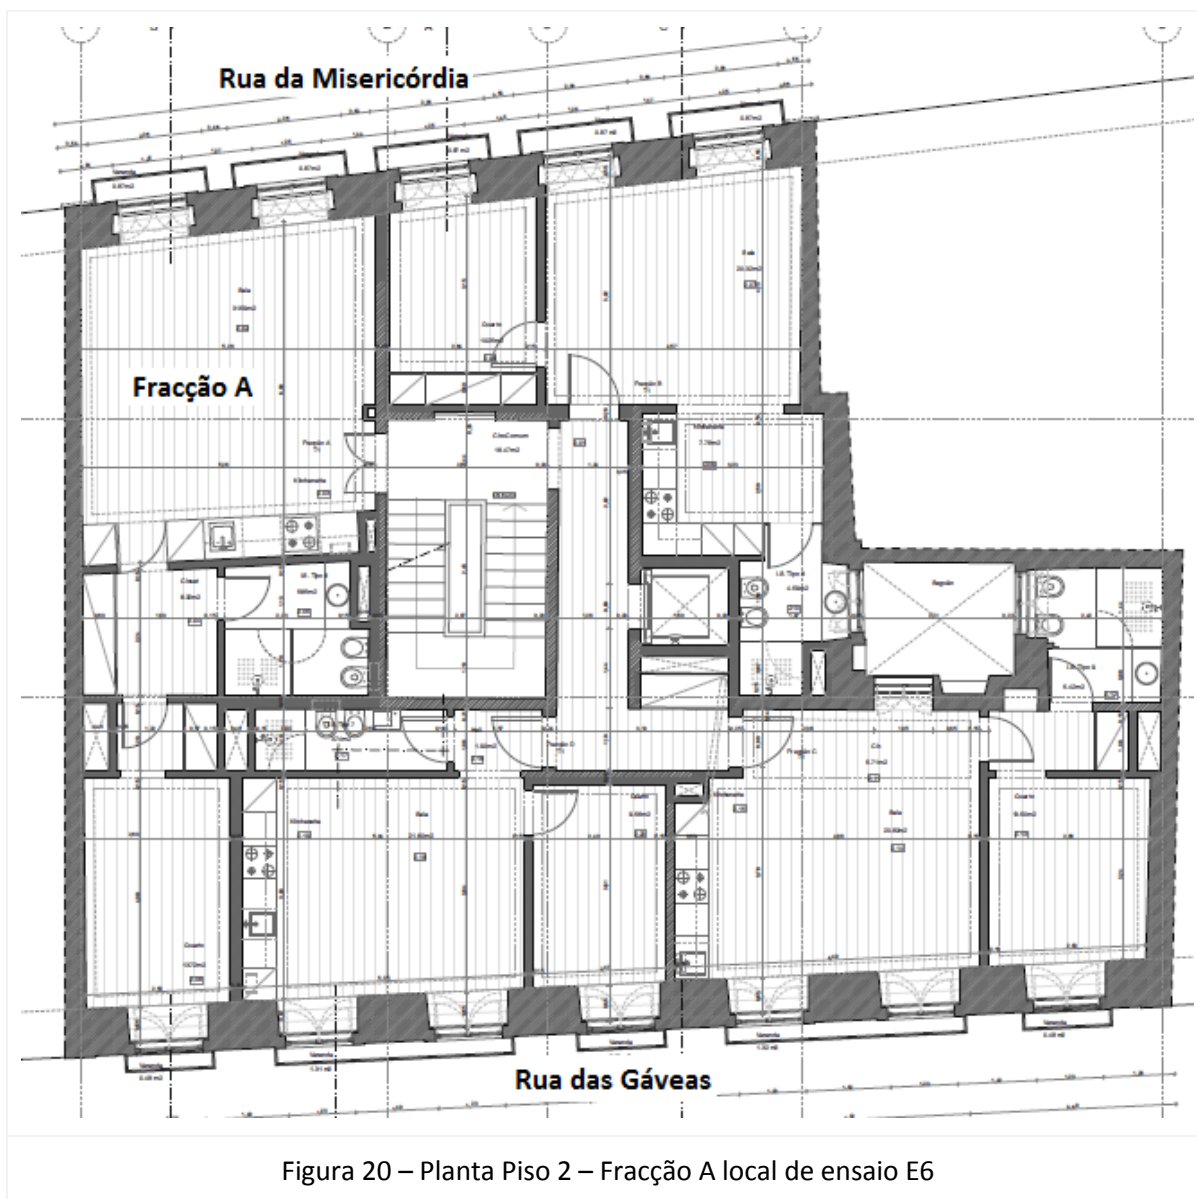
Planta Piso 2 – Fracção A local de ensaio E6
